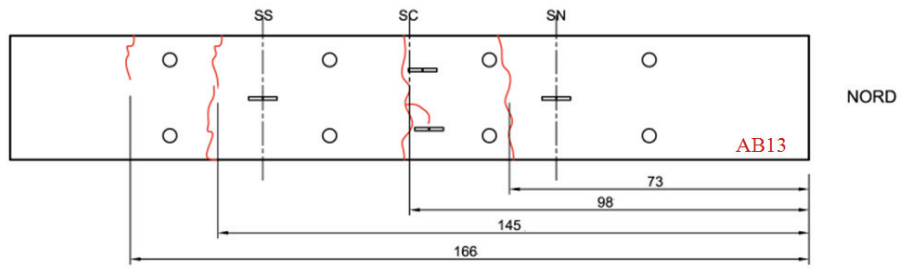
Relevé des fissures pour la poutre AB13
